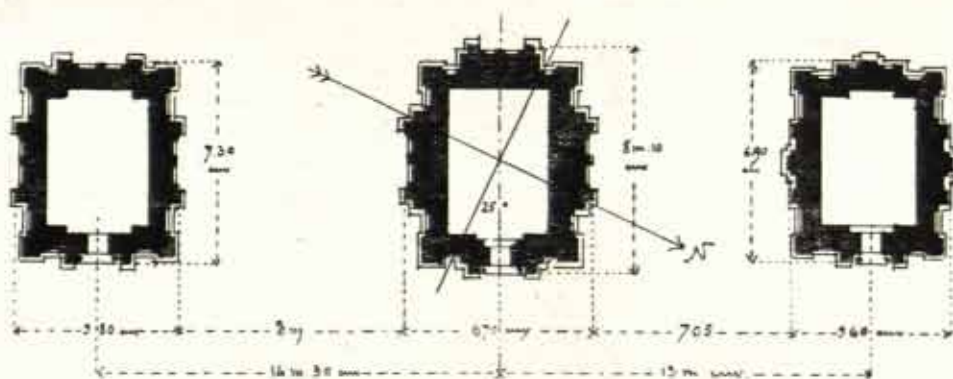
GROUPE DE TRAPÂN PRÔH. Plan d'ensemble.
